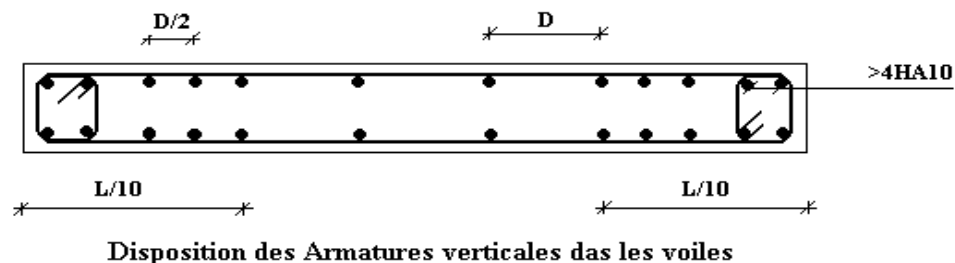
Disposition des Armatures verticales dans les voiles.
